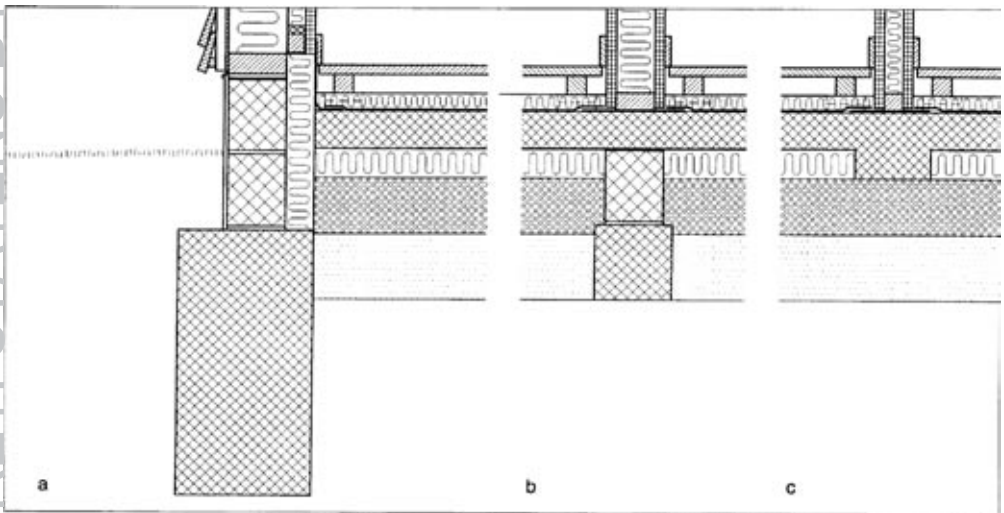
Kuldebroen gennem fundamentets øverste del (a) er brudt af letklinkerbetonblokke med et isolerende midterlag. Der tættes mod radonindtrængning over kantisoleringen ved at klæbe murpappen til betonpladen. Kan bagvæggen kun anses for tæt over for radon, hvor den er udført med overfladetætning, kan paplaget over kantisoleringen i stedet føres op og klæbes til bagvæggen sådan, at paplag og overfladetætning overlapper hitvunden (vist stiptet). Figuren viser tillige en bærende (b) og en ikkebærende indervæg (c). Pap under indervægge klæbes tæt til betonpladen.
